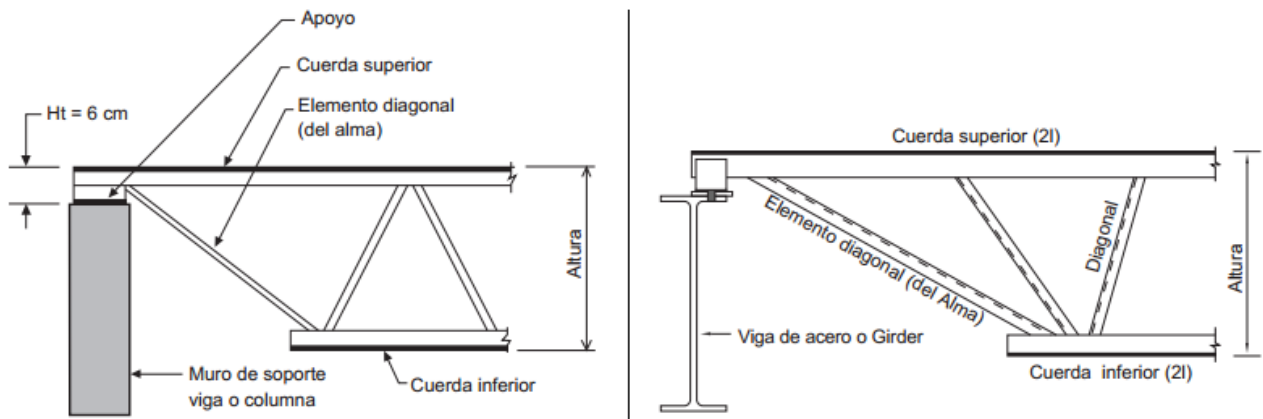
Unión estructural viga Joistec, a columna o viga metálica. (Archdaily, 2014)
